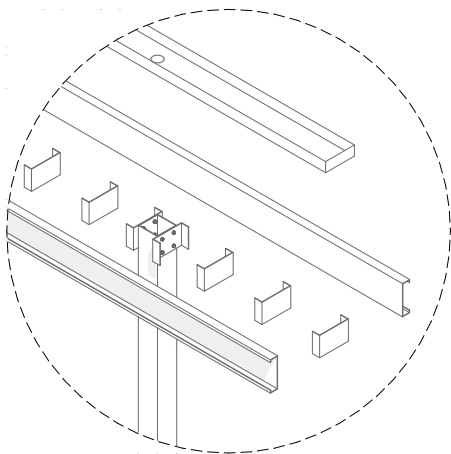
Fixação da viga no pilar através de ligação parafusada.
